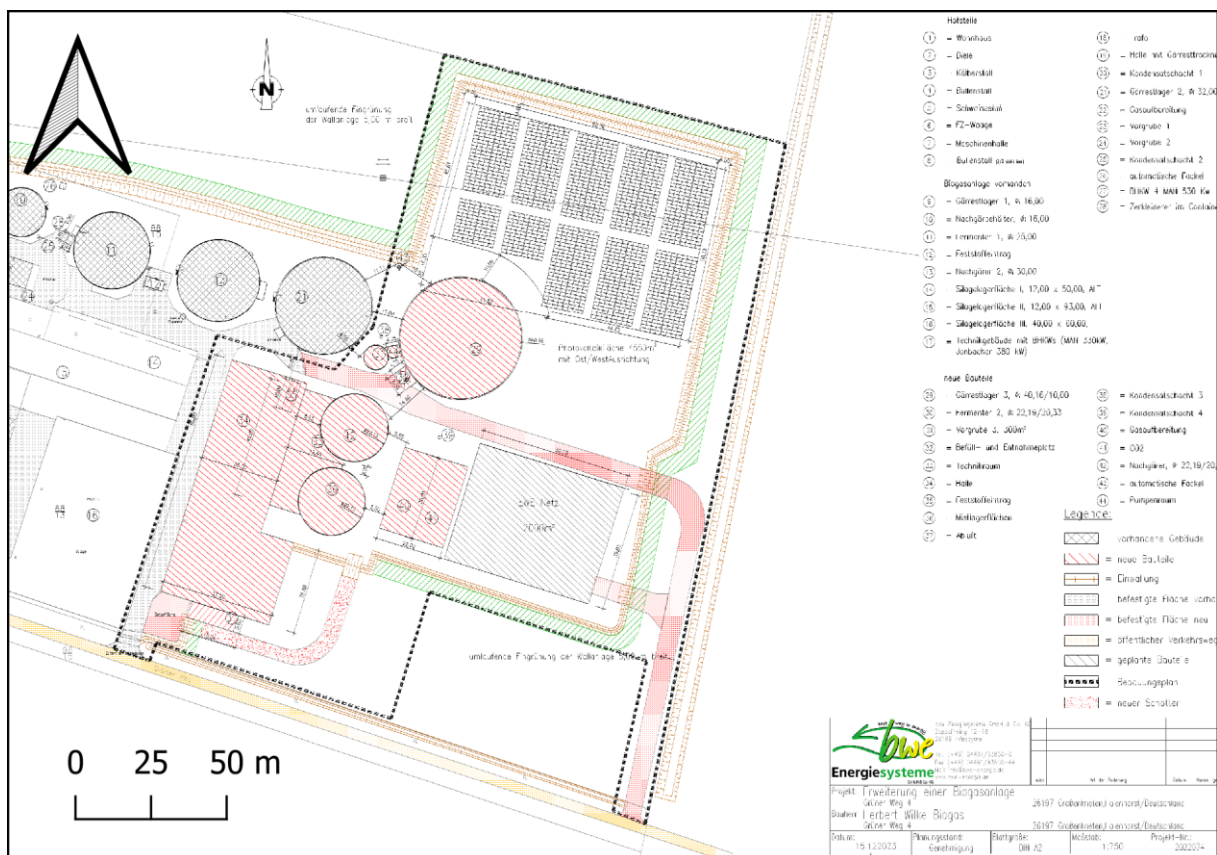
Ausschnitt aus Lageplan des Vorhabens vom 15.12.2023 im Geltungsbereich (schwarz gestrichelte Linie) des Bebauungsplans Nr. 142 „Biomethananlage Grüner Weg“ der Gemeinde Großenkneten. M 1:2.500.
